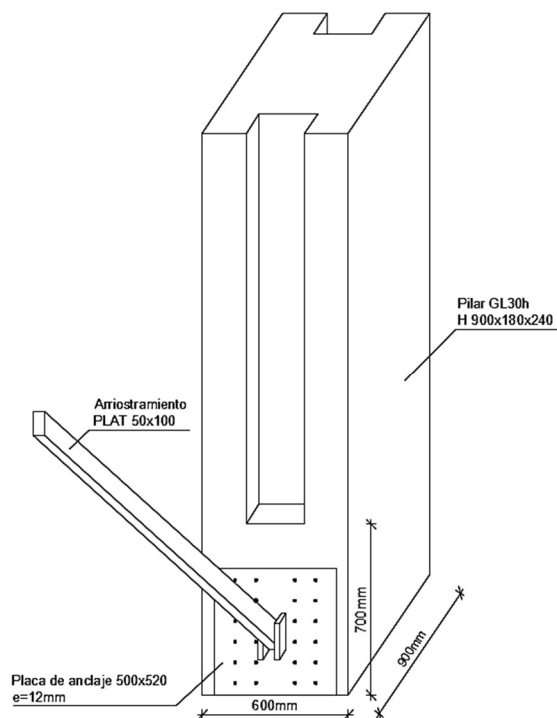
Detalle de la disposición de los elementos de fijación. Esquema del resultado final de la unión de los arriostramientos.
